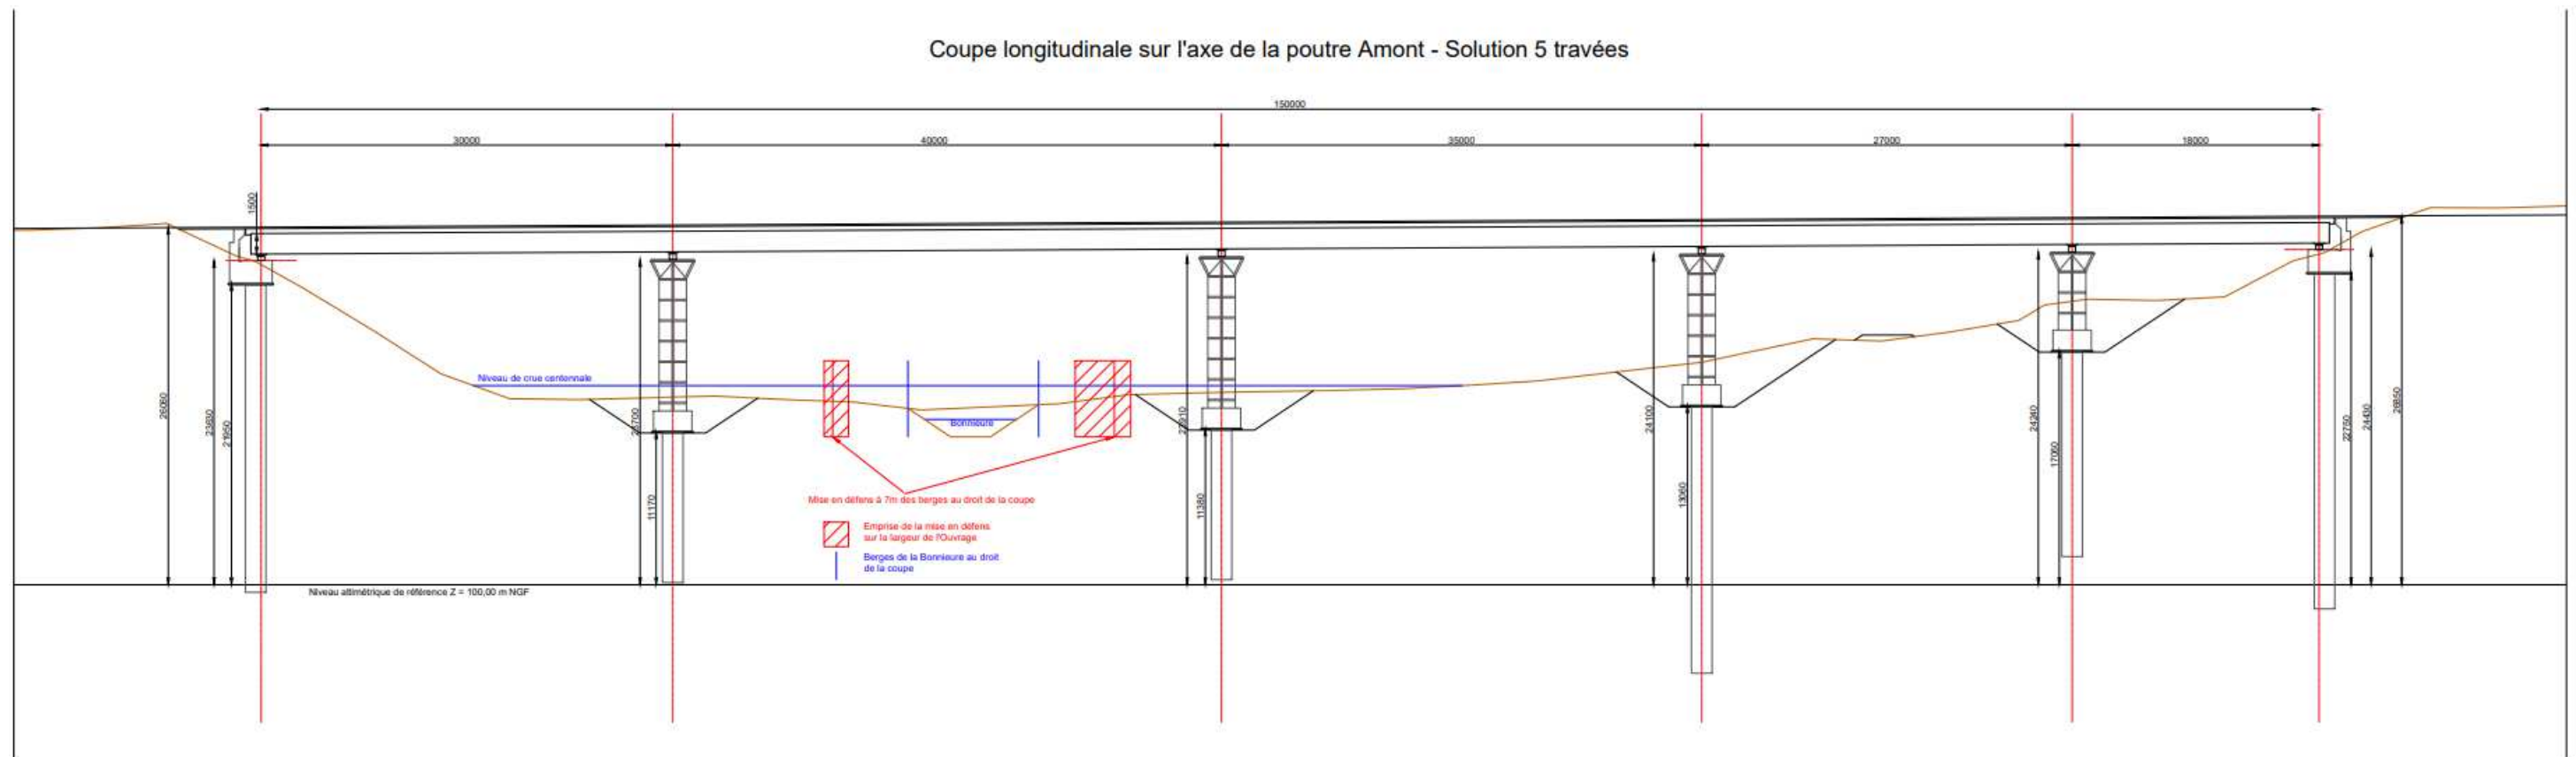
COUPE LONGITUDINALE SUR L'AXE DE POUTRE AMONT - SOLUTION 5 TRAVEES
